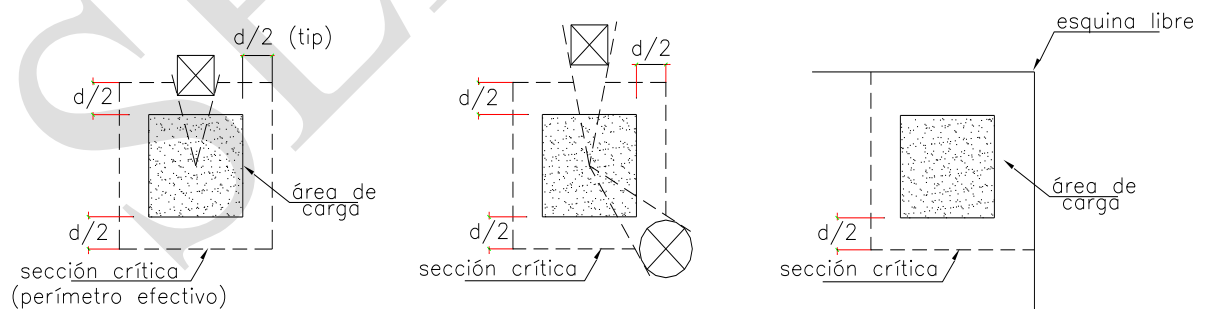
Aberturas y bordes libres en losas (las líneas discontinuas muestran el perímetro efectivo).
